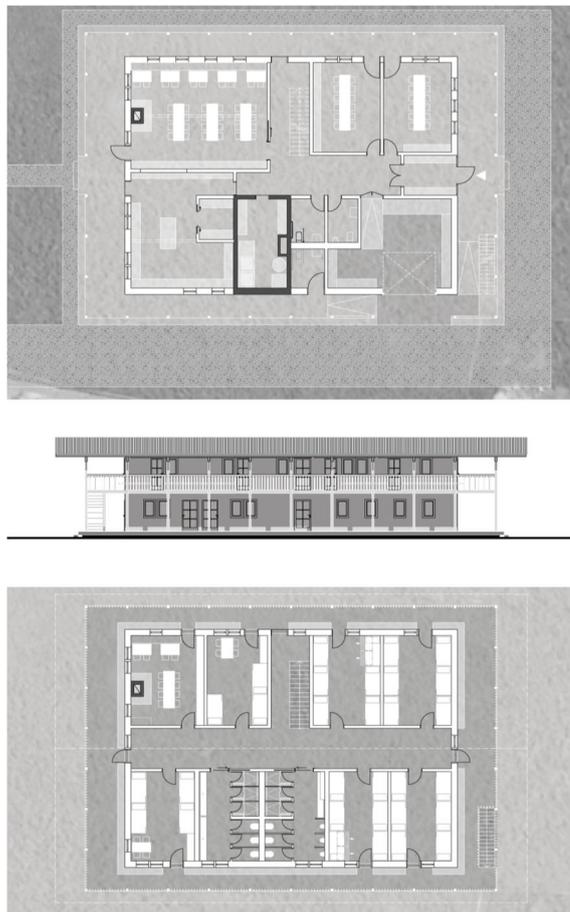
Projekt mit Grundrissen und Ansicht,
